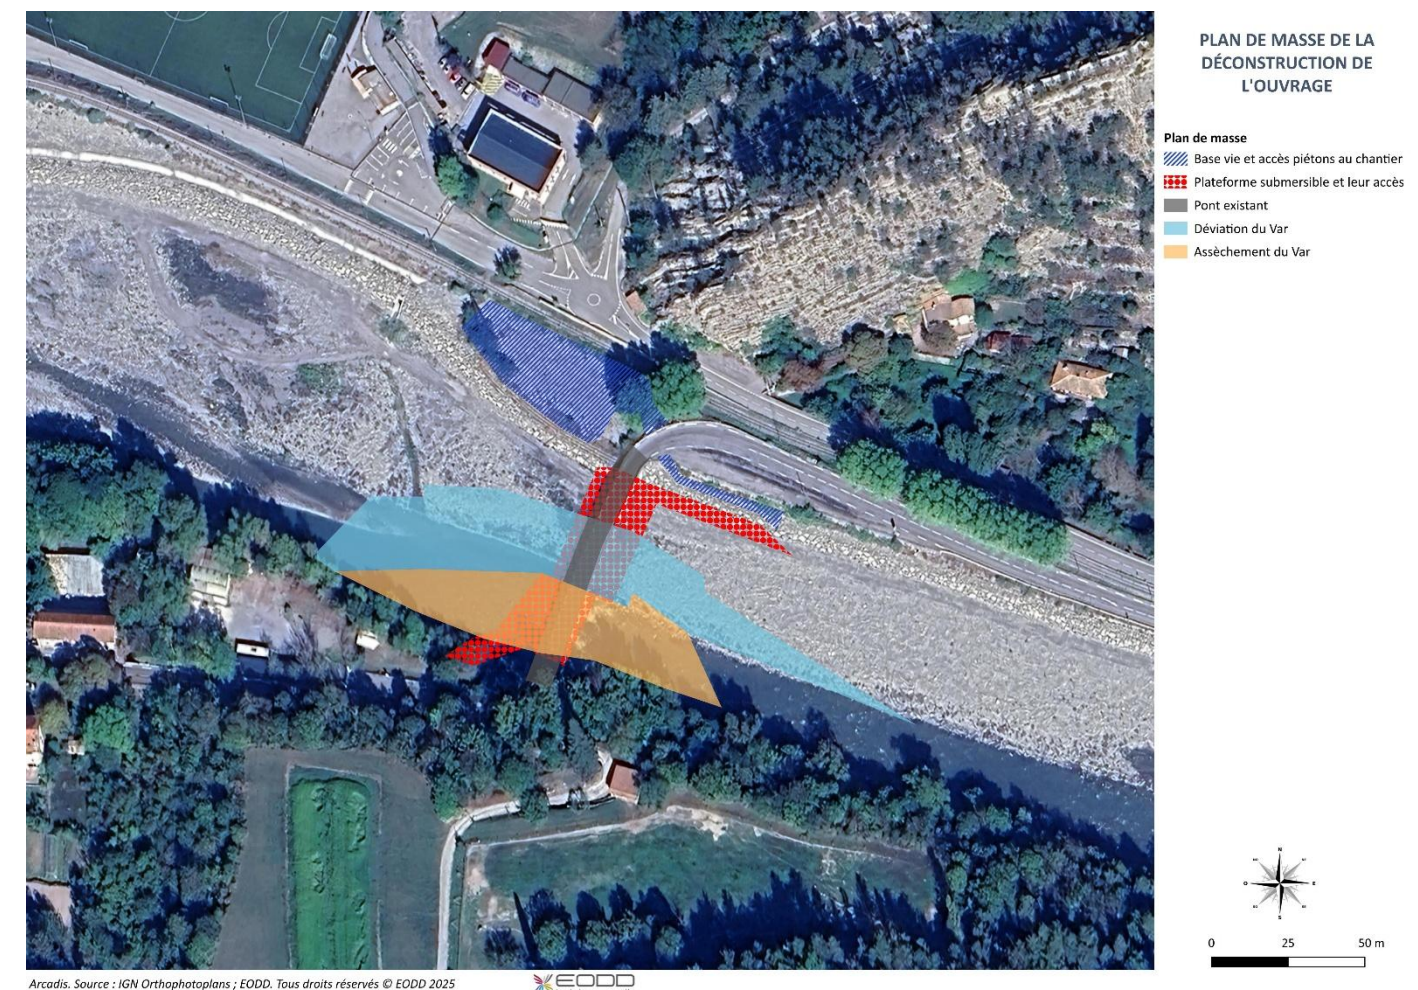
plan de masse de la déconstruction de l'ouvrage existant
